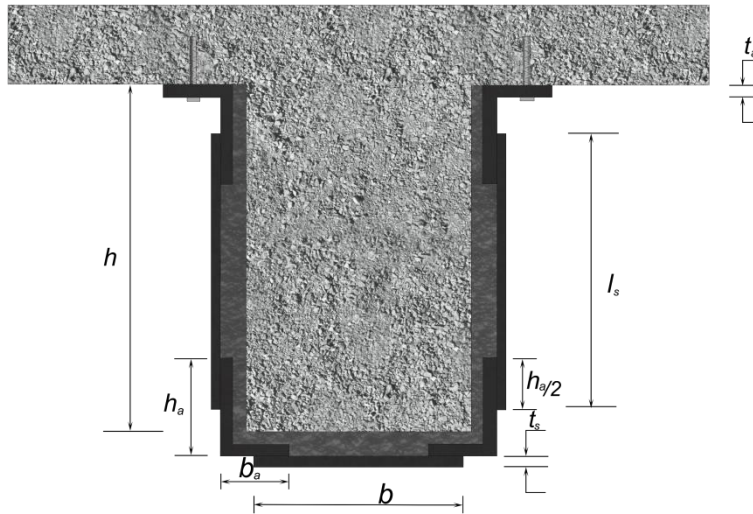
Sección transversal de viga encamisada con ángulos y solera.
